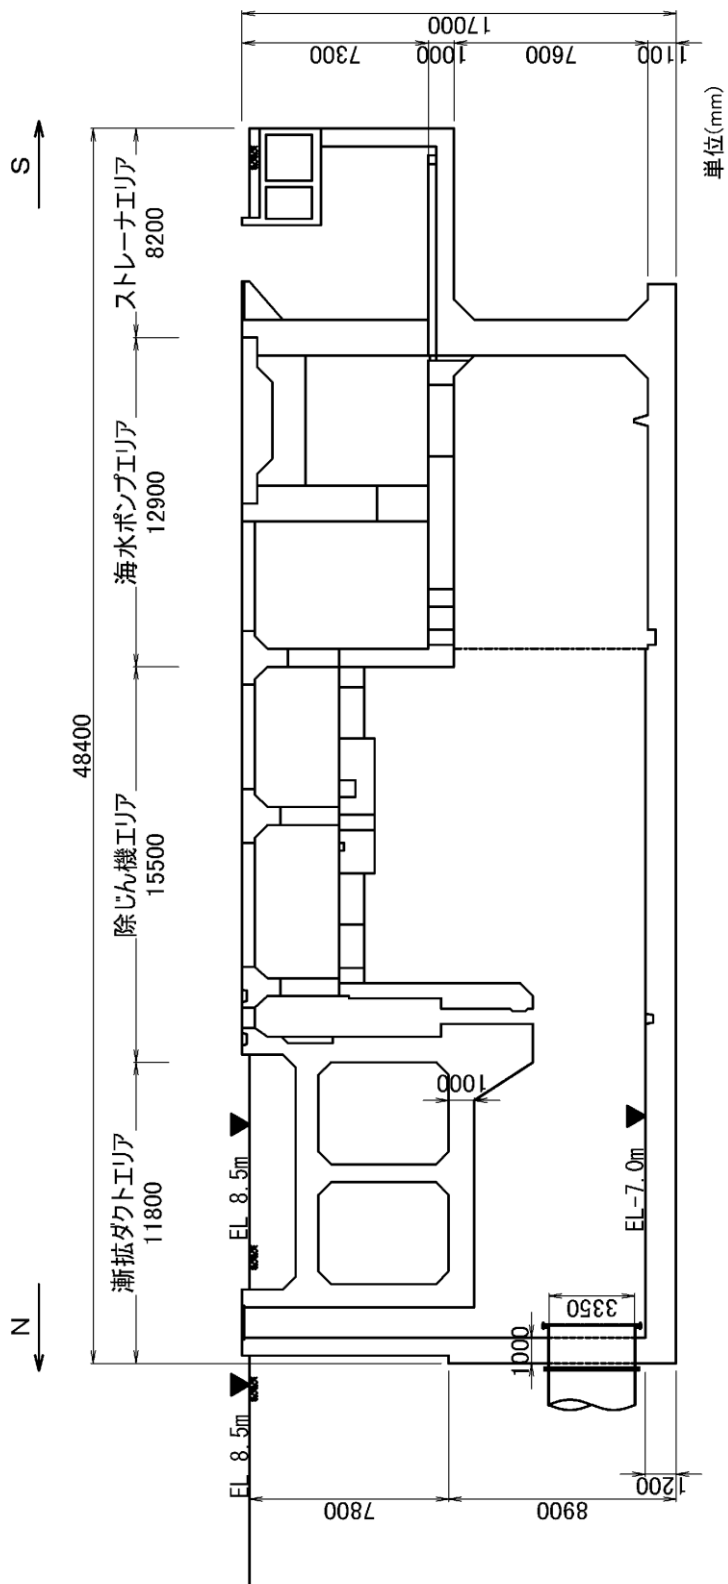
2. 2-2 1号機取水槽 断面図(A-A断面)
